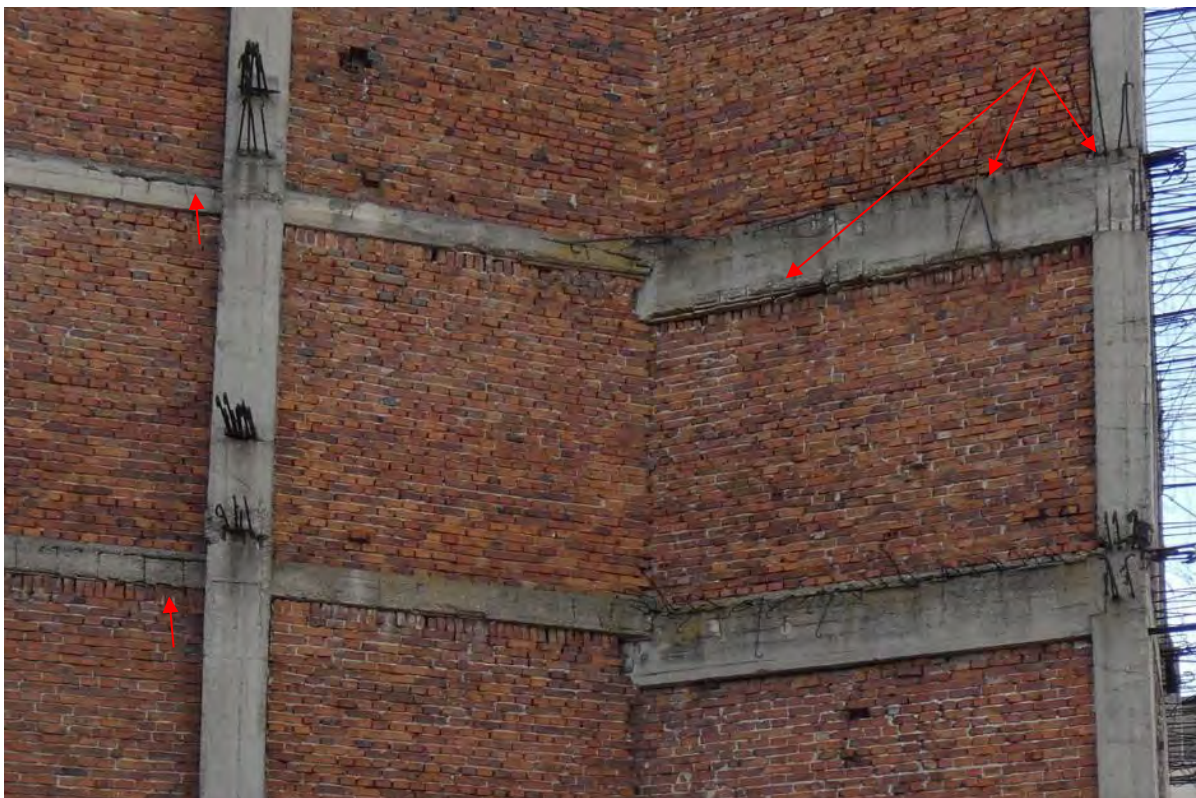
Armari neconforme ale elementelor din beton armat (pas etrieri zona critica grinzi). Expulzari ale betonului la intradosul grinzilor si in nodul de cadru
